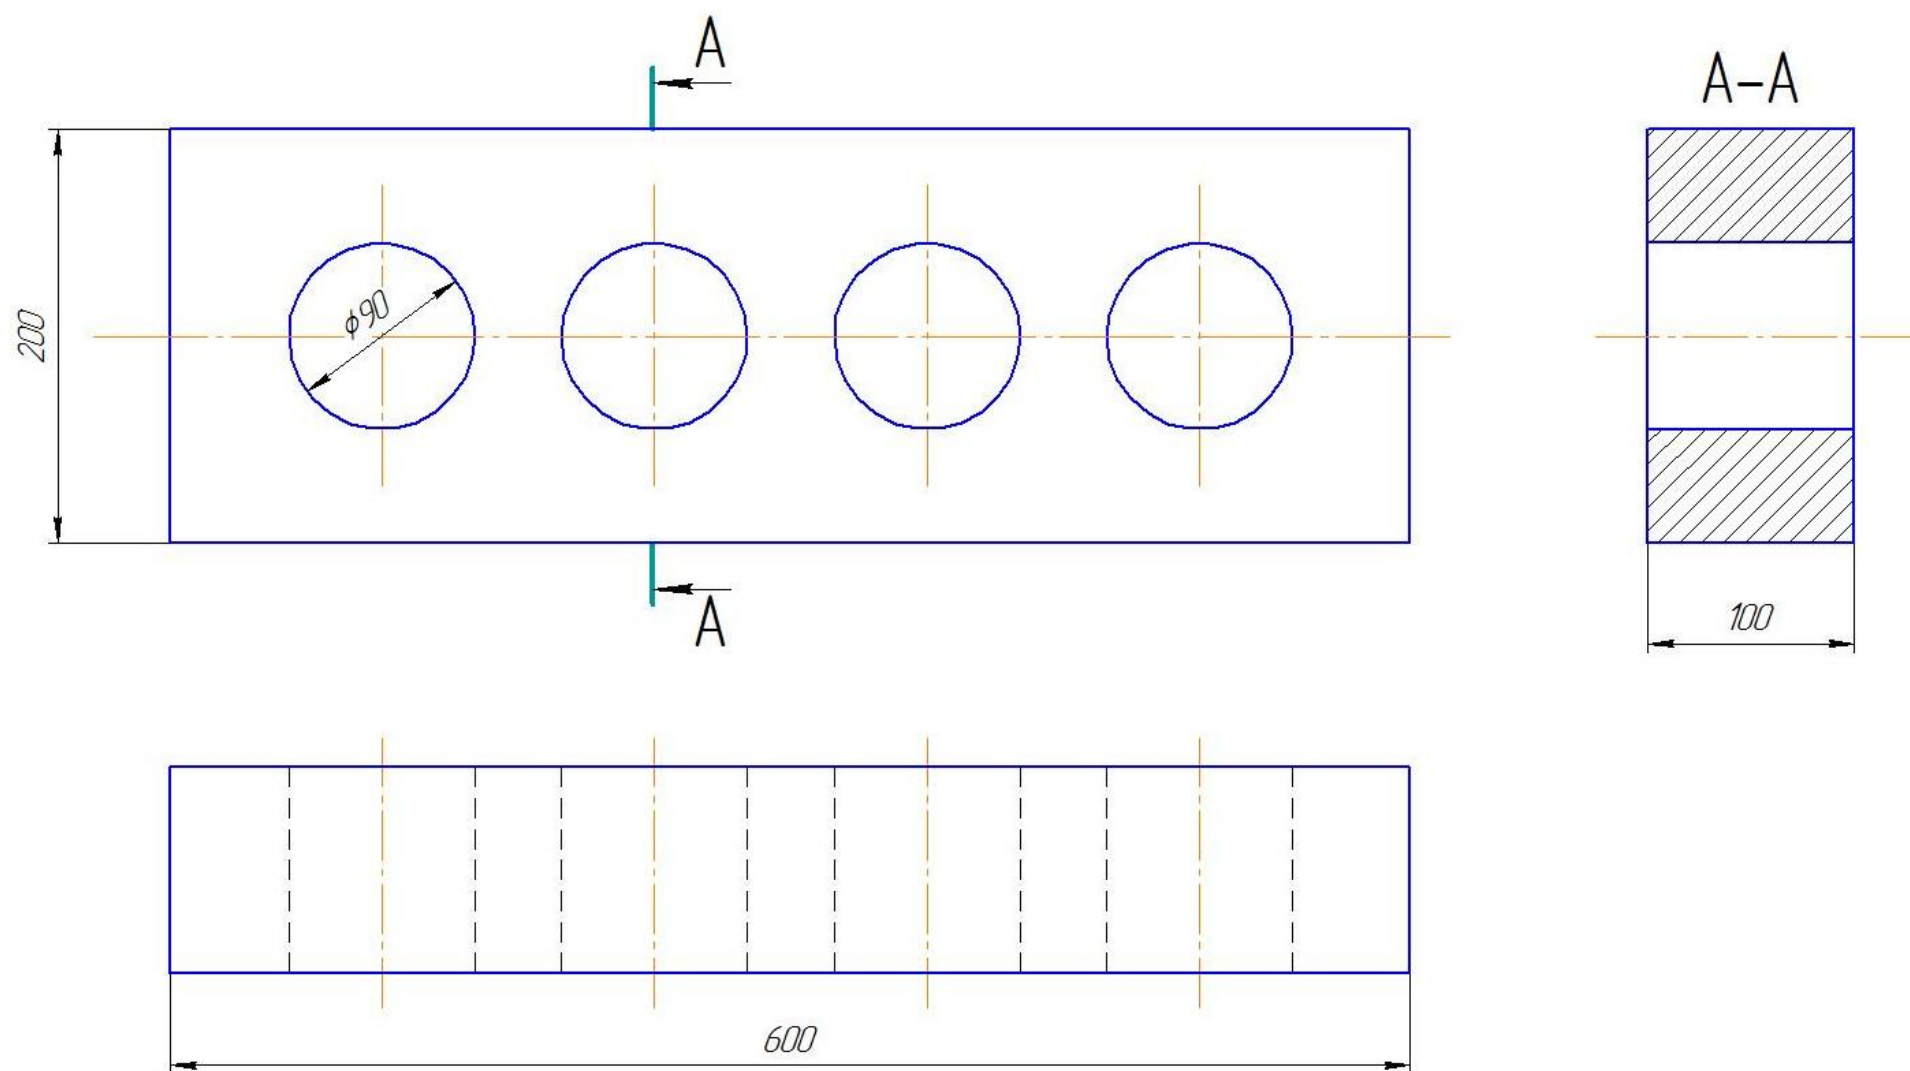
Креслення газобетонного блоку з 4-ма колоподібними отворами
